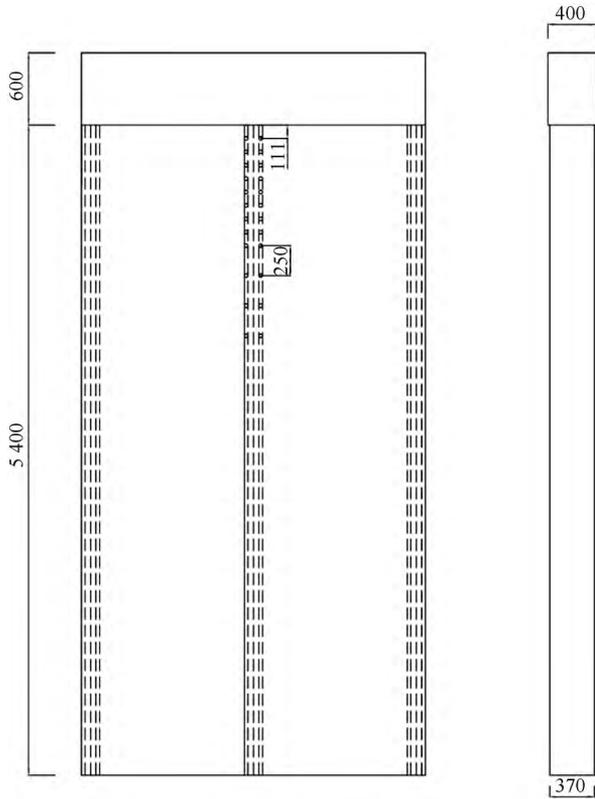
钢筋混凝土组合坝墙侧视(单位: mm)
